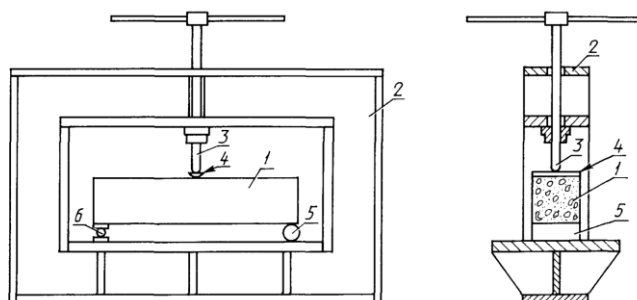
Схема проведения равновесных испытаний образцов: 1 – образец; 2 – загружающее устройство; 3 – нагружающий винтовой силоизмерительный шток; 4 – распределительная балка; 5 – роликовая опора; 6 - шарнирная опора
